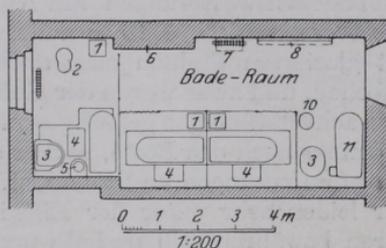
München-Schwabing. Städt. Krankenhaus. Baderaum.
